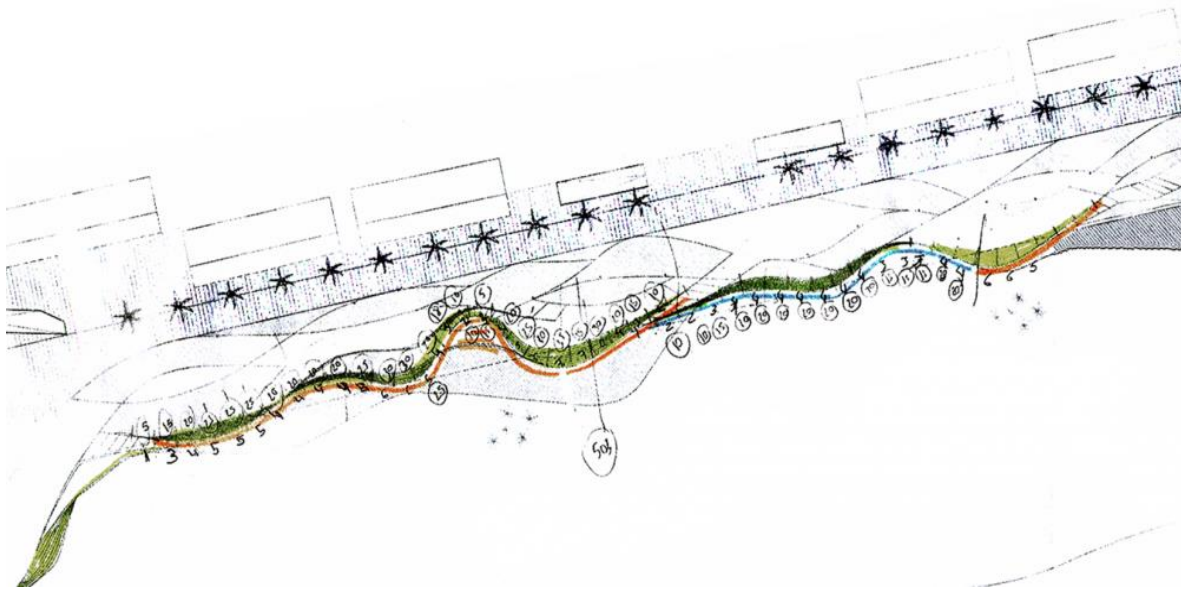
Plantas Arquitectónica y de conjunto del paseo Marítimo.
